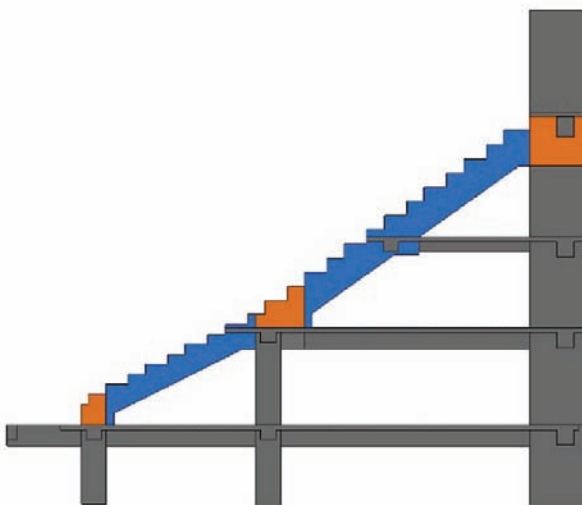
Secțiune curentă Peluza Sud – legendă culori: gri – elemente beton monolit, portocaliu – monolitizări îmbinări, albastru – grinzi tip „raker beam” prefabricate
